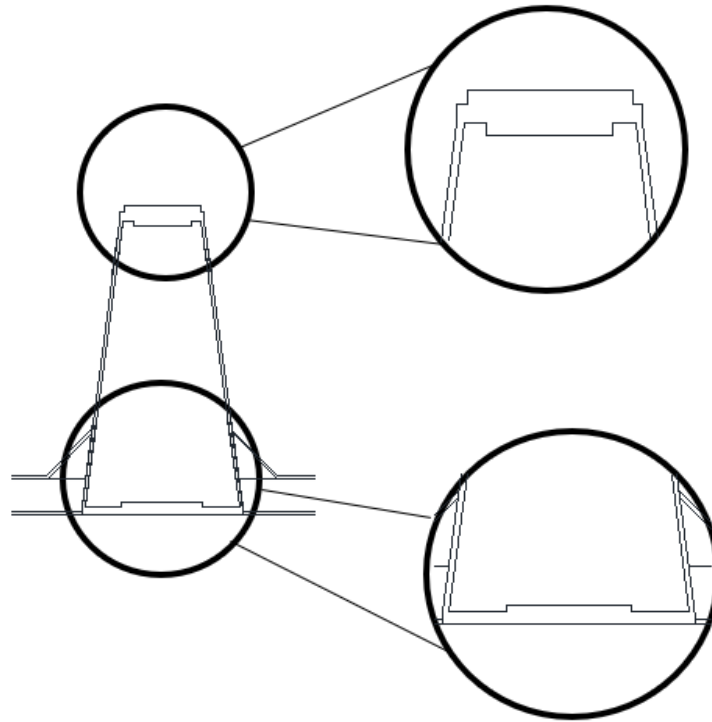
Pormenor superior e inferior do reforço na longarina central na zona longarina central
